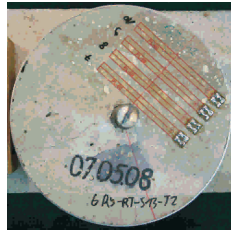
Rissbilder der Ringtests, Beton C20/25
